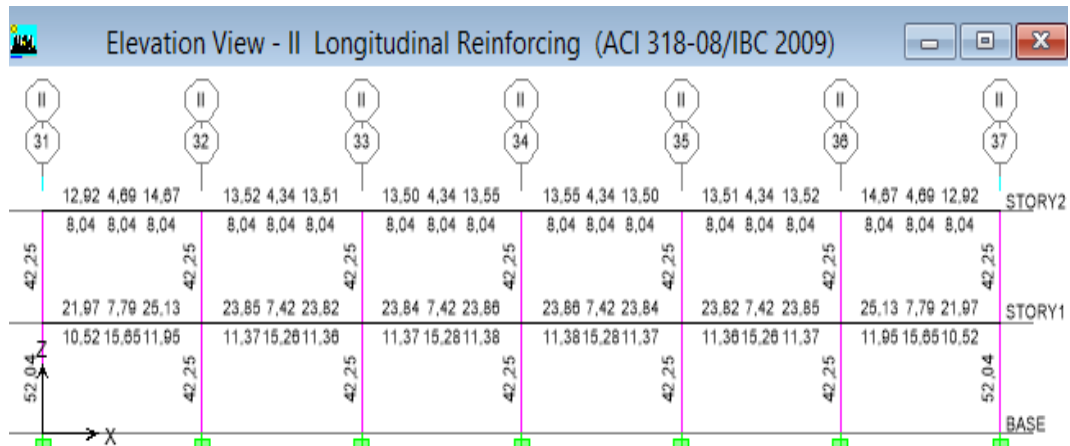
Acero en Vigas y Columnas en el Pórtico II – C. Quirúrgico- (NEC-11)
